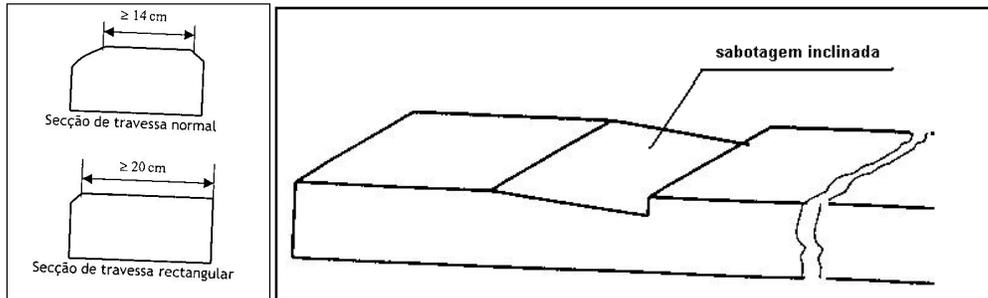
Características das travessas de madeira (Adaptado de [41])
